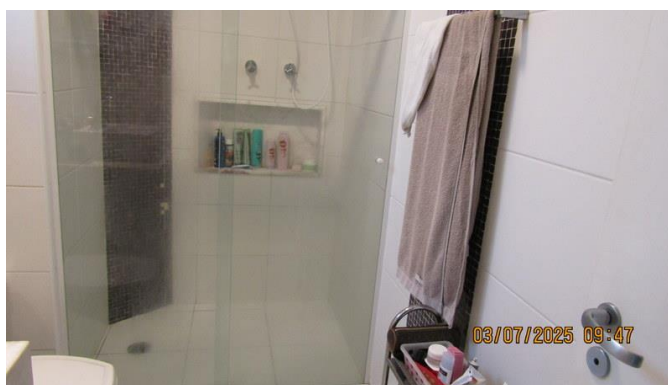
Outra vista do WC da suíte do imóvel avaliando.
